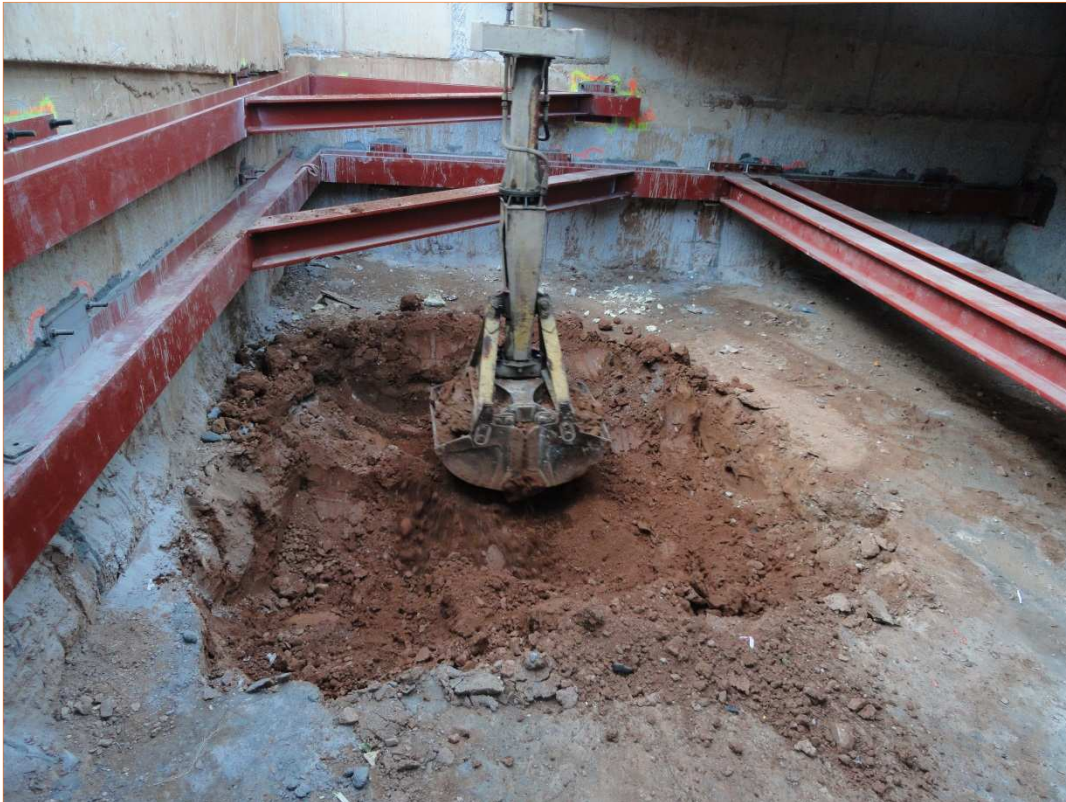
Vista dels treballs de rebaix de la primera fase de la sortida d'emergència.
